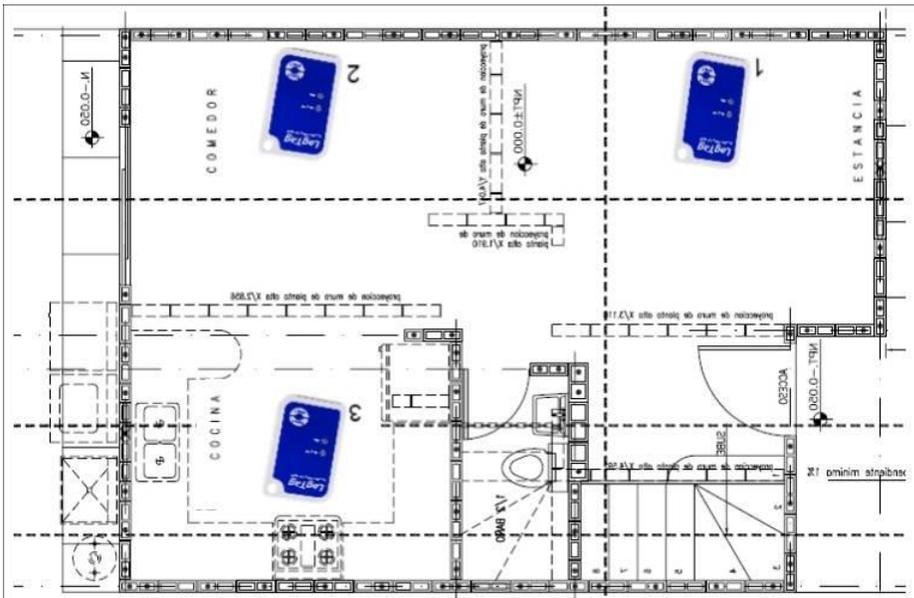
Planta arquitectónica de la vivienda uno, primer nivel Orientada al Este
